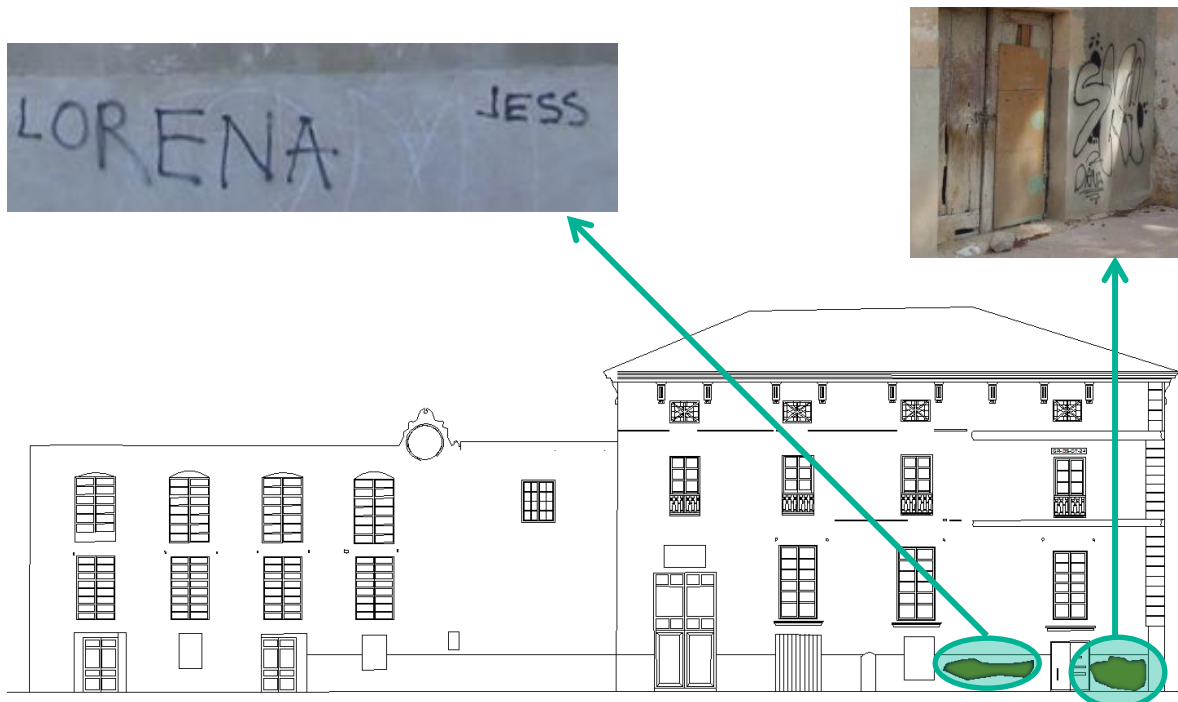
Alzado plaza. Grafitis. Fuente: Elaboración propia
